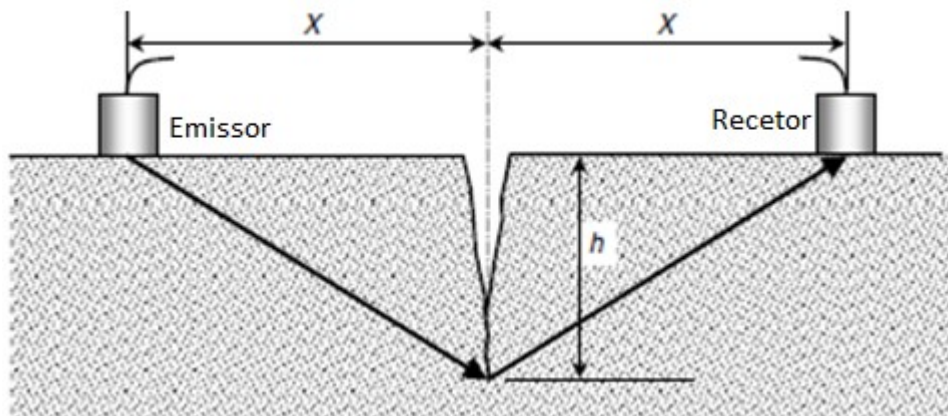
Medição de profundidade de fissura. [5]
